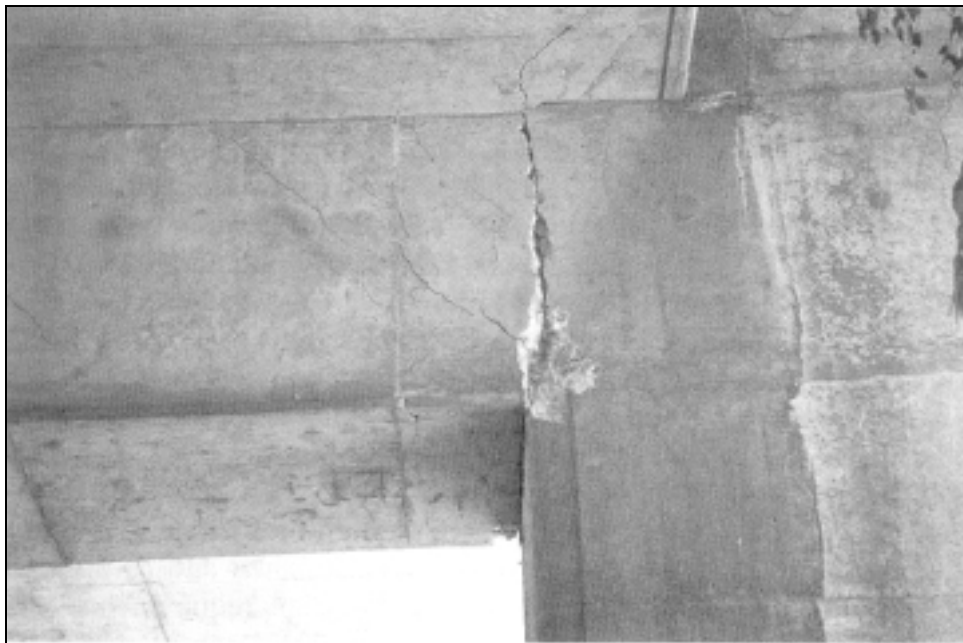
Grietas por momento positivo en viga cabezal sobre la cara inferior de la columna, terremoto de Loma Prieta de 1989.
